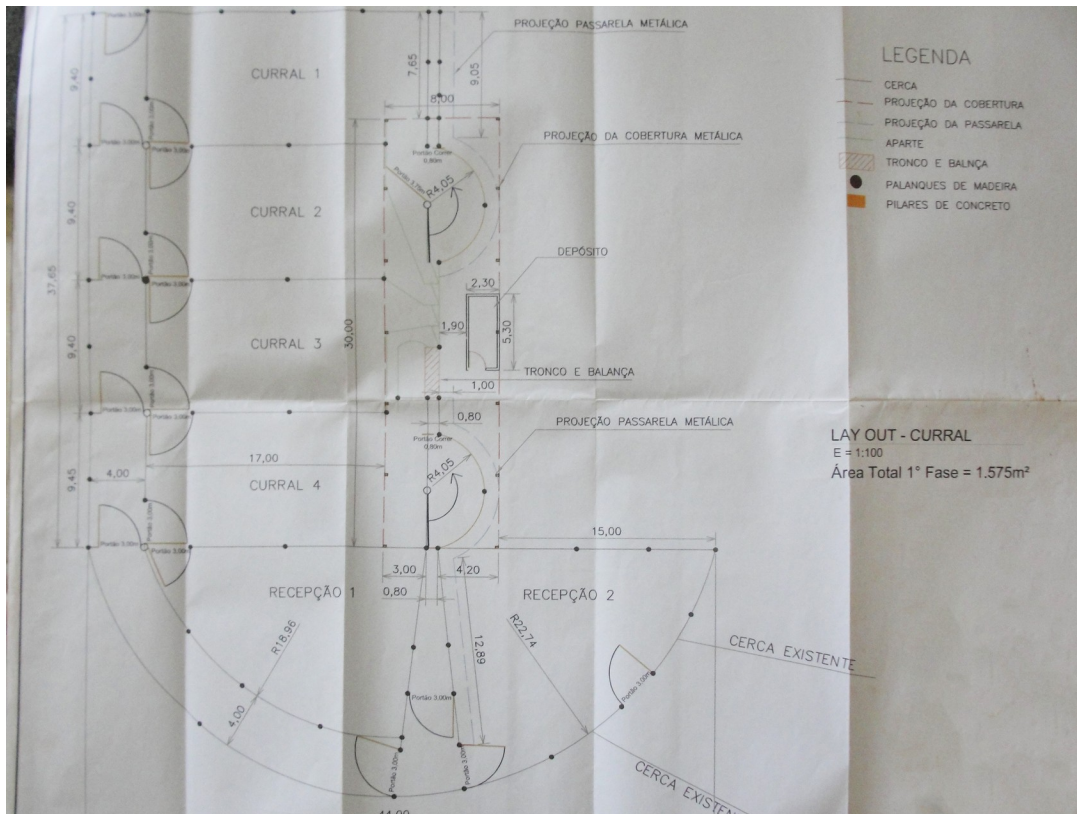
Planta baixa do curral da Unidade Beatriz (MT)
